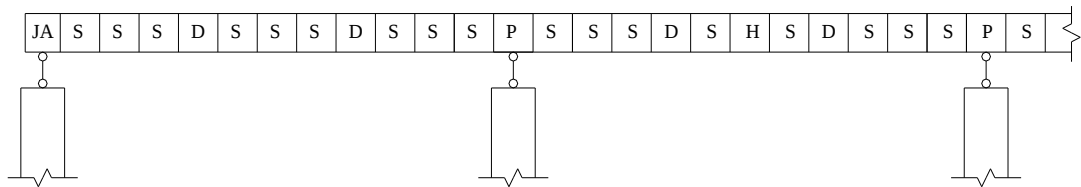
悬臂拼装施工的箱梁节段布置示意图
